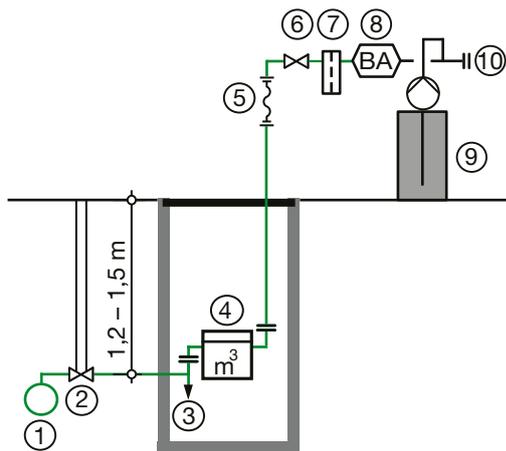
Feldbewässerung mit Zäblerschacht wasserdicht und auftriebssicher mit demontierbarem Standrohr
